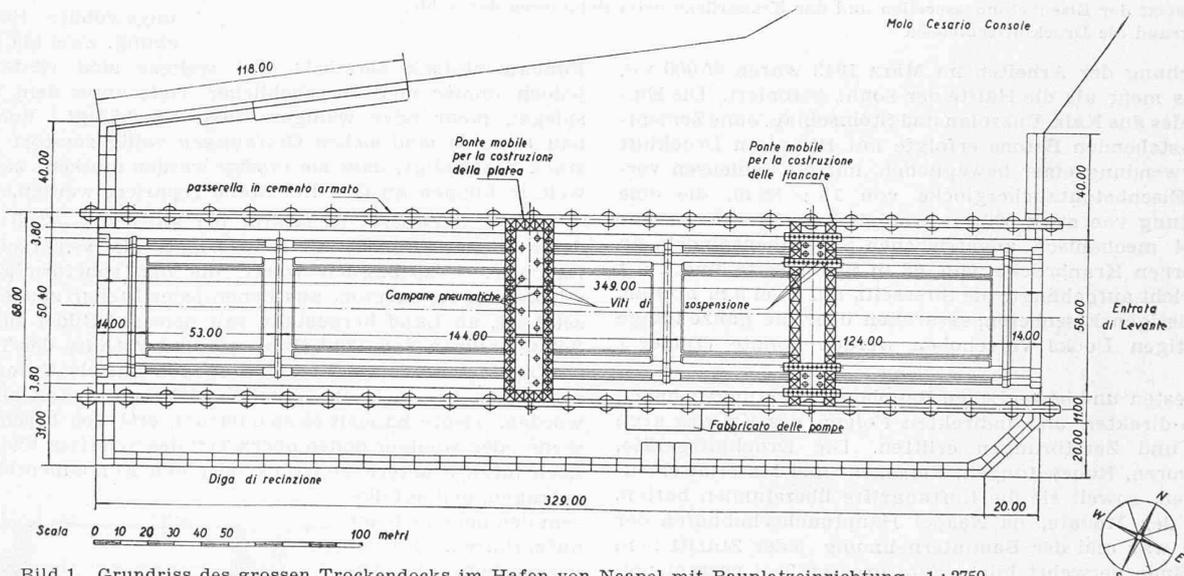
Grundriss des grossen Trockendocks im Hafen von Neapel mit Bauplatzeinrichtung. 1 : 2750
